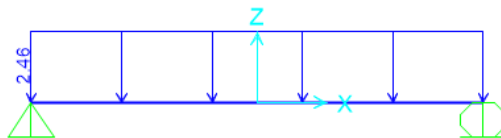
Modelo estructura losa tipo II (ton/m)
